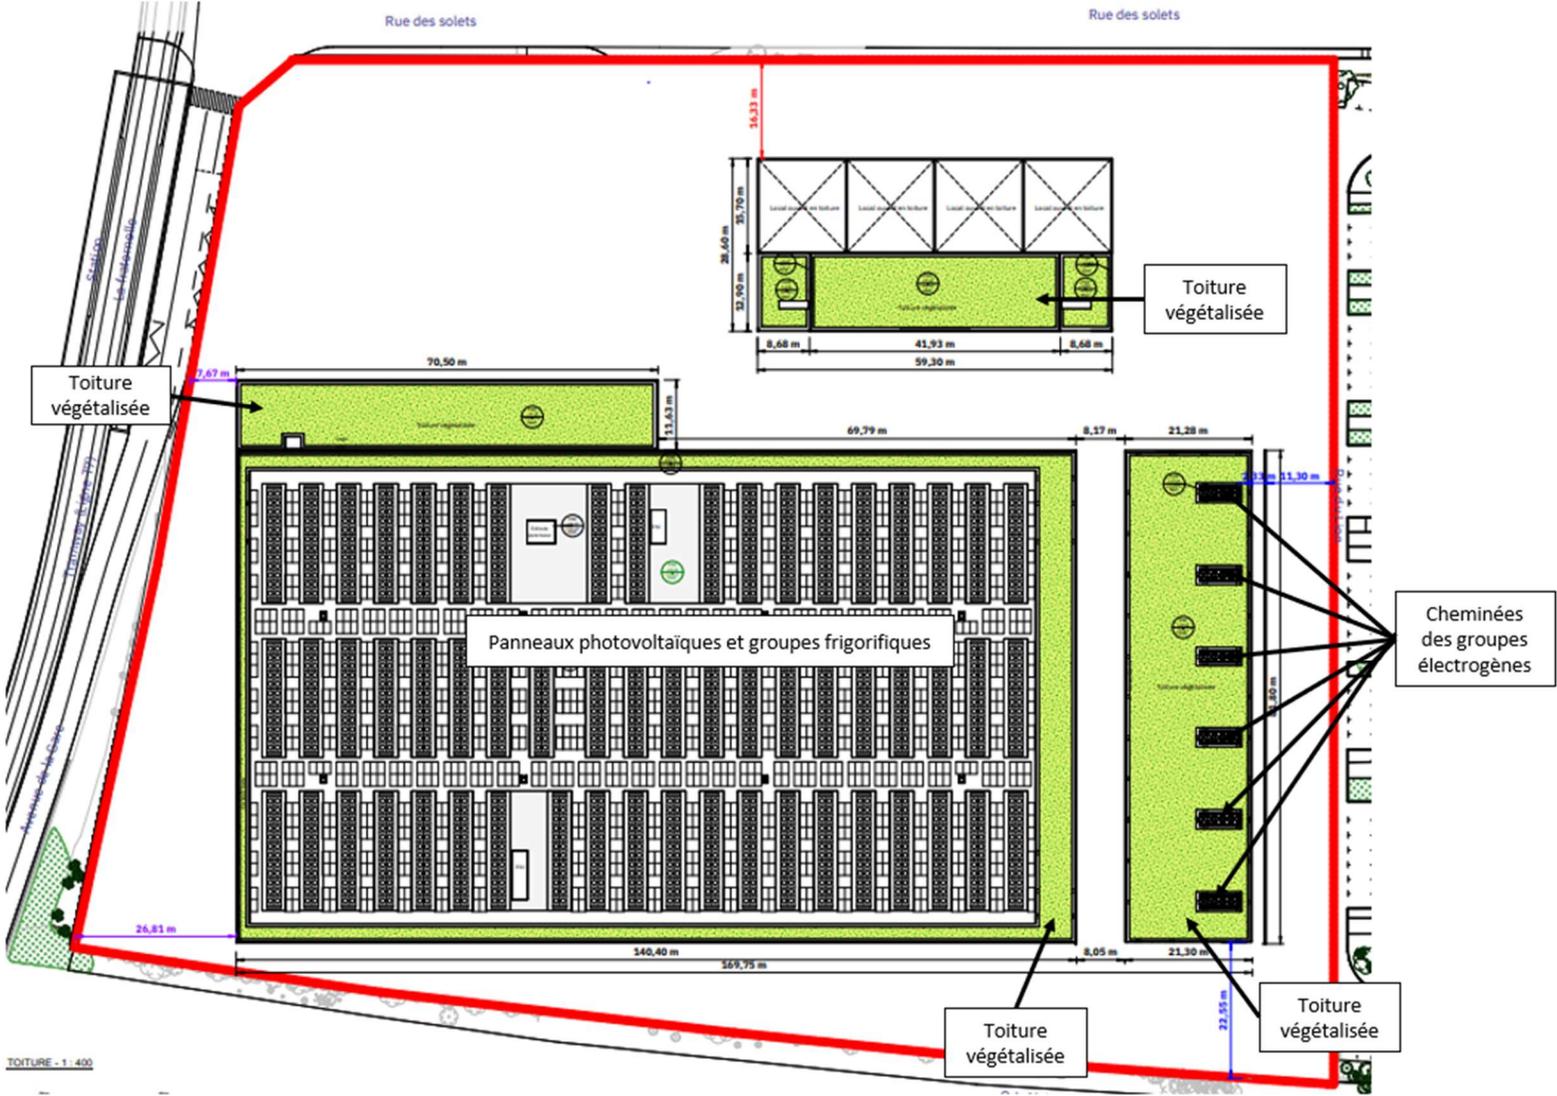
Plan de la toiture des bâtiments principaux (source : ENIA Architecte)
